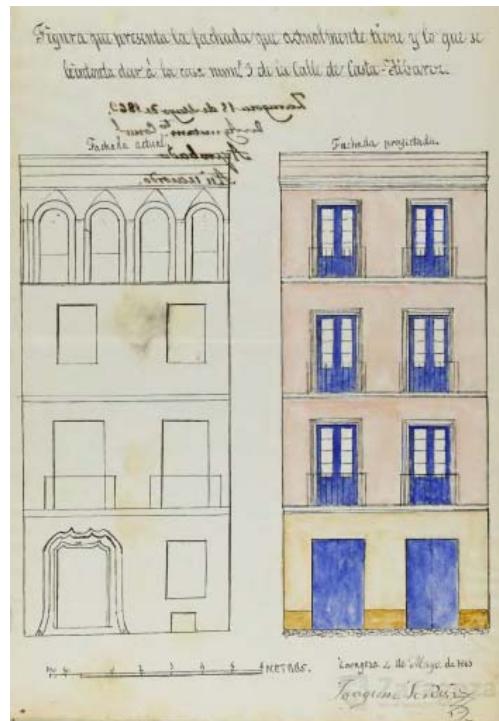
Proyecto de reforma de la fachada del edificio situado en calle de Casta Álvarez, núm. 3, Zaragoza, por el arquitecto Joaquín Jordán, 4 de mayo de 1863 (AMZ).
